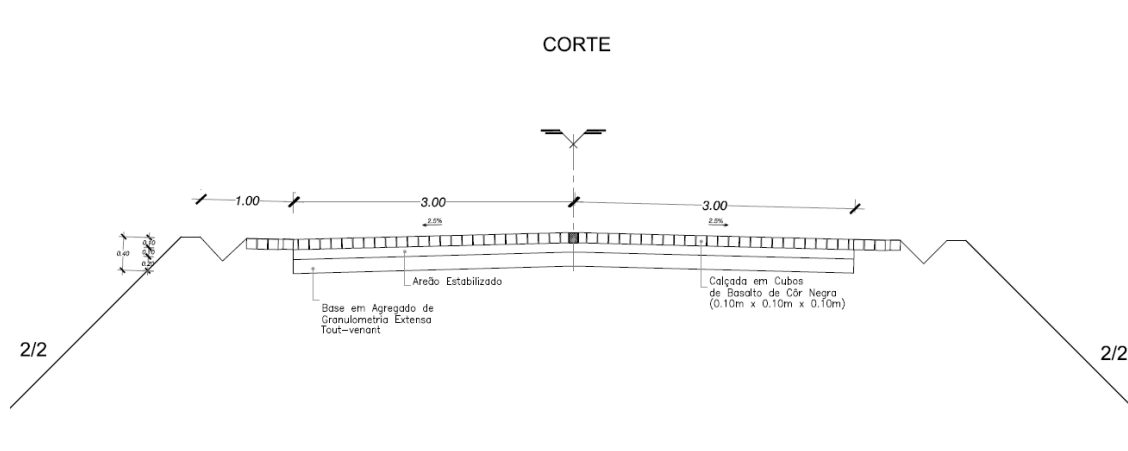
27:perfil transversal tipo 2- Ilha de São Nicolau (Instituto de Estradas de Cabo Verde, 2015)
